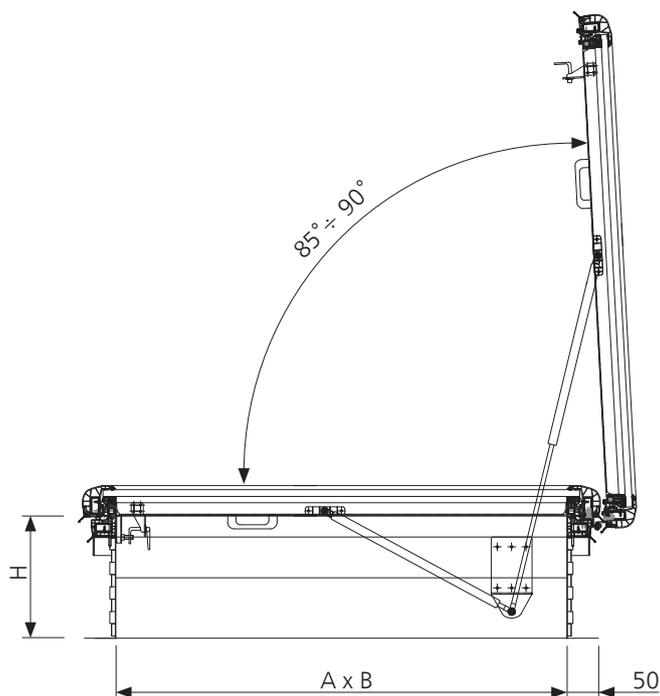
Coupe transversale B-B de la trappe de toit mcr ULTRA THERM C en position ouverte, dimensions en mm
